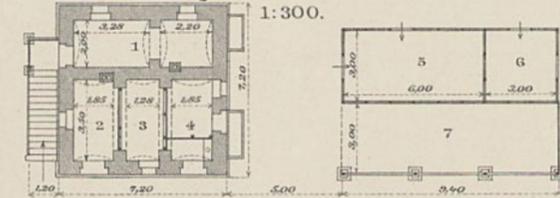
u. 9. Grundrisse des Erdgeschosses.
